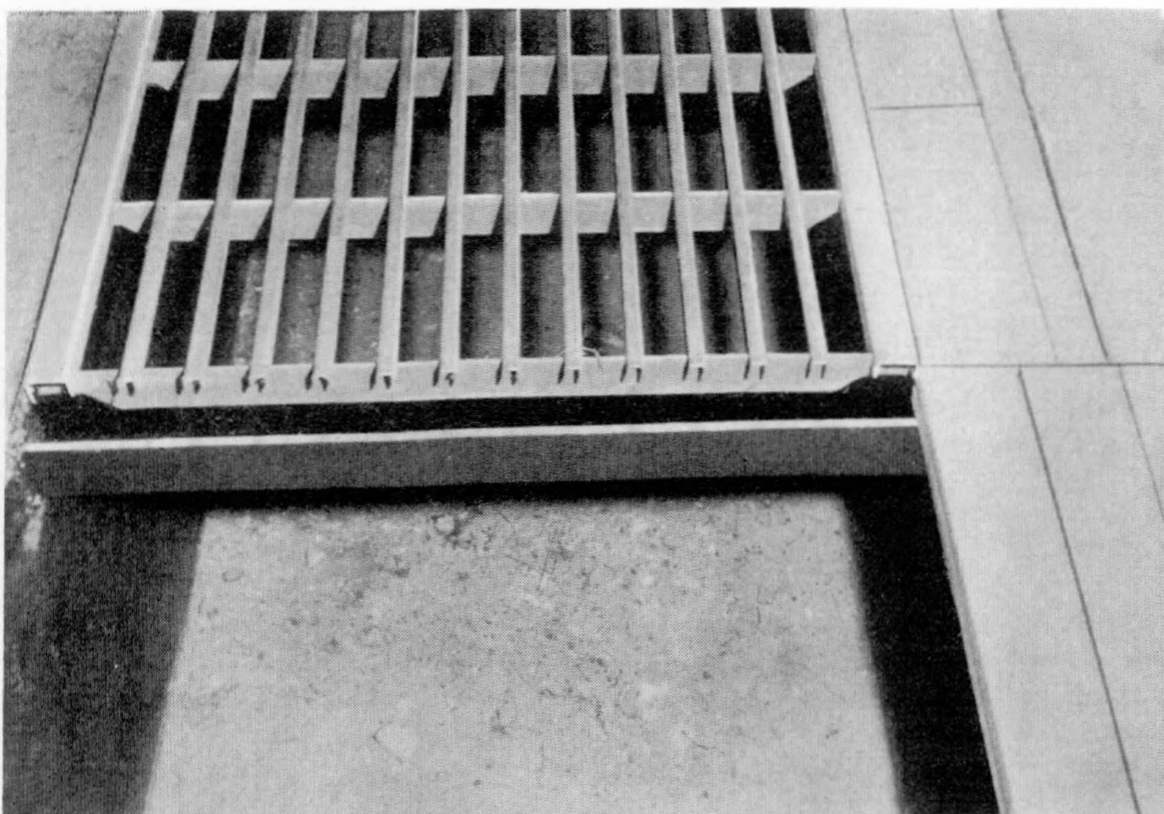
Statt eines T-Trägers zur seitlichen Auflage können auch zwei hochkantig eingebetonierte Flacheisen verwendet werden. Sie ermöglichen einen besseren Kotdurchgang
